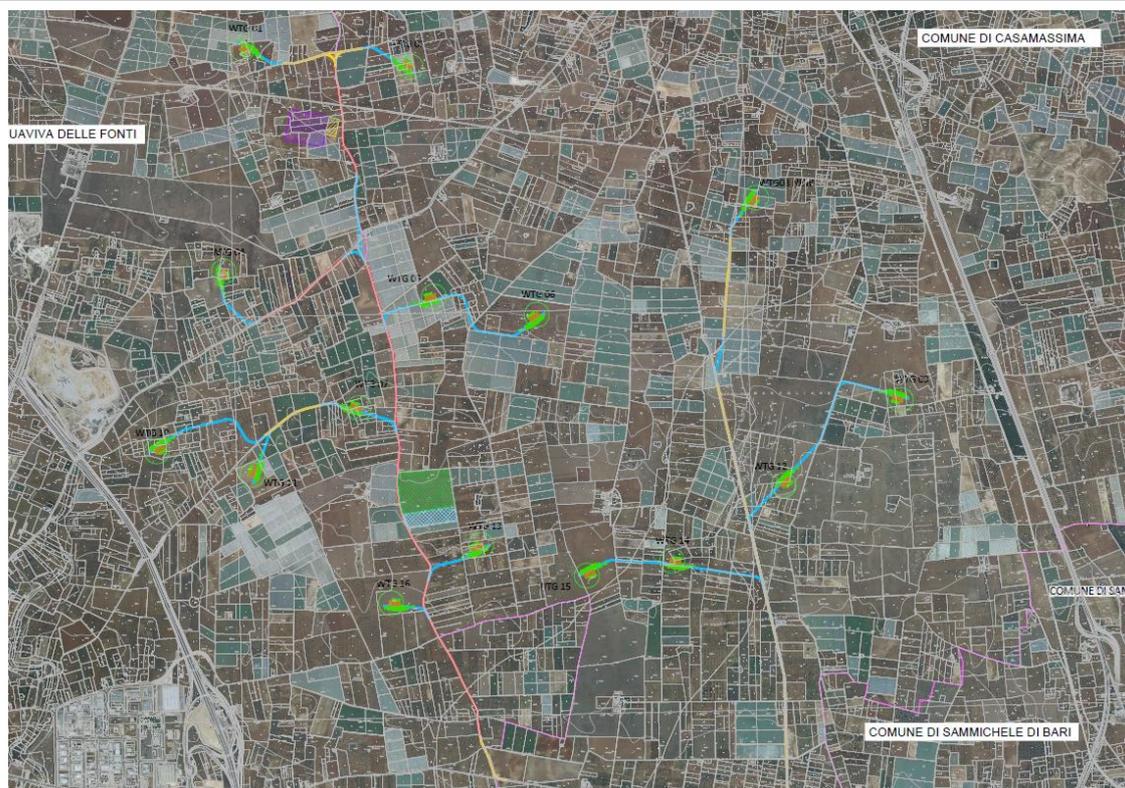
Individuazione su ortofoto dell'impianto in progetto
